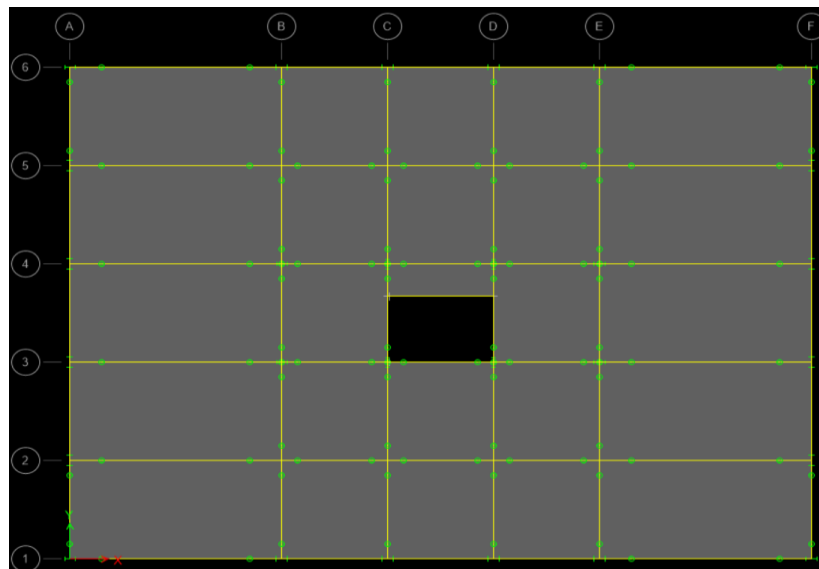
Vista en planta de la ubicación de las escaleras en la edificación.
